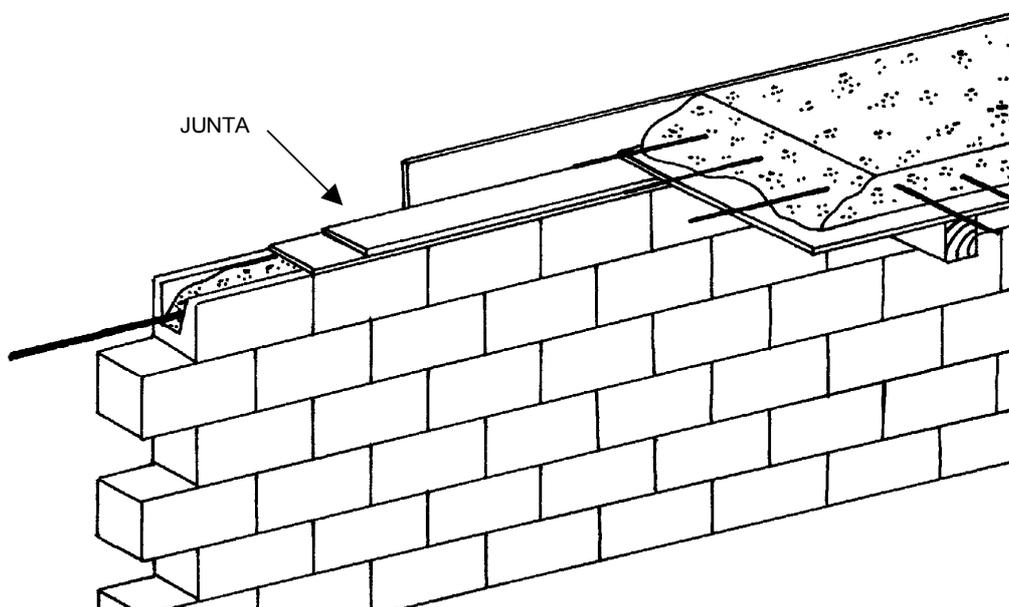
Detalhe do acabamento entre a alvenaria e a laje de cobertura
